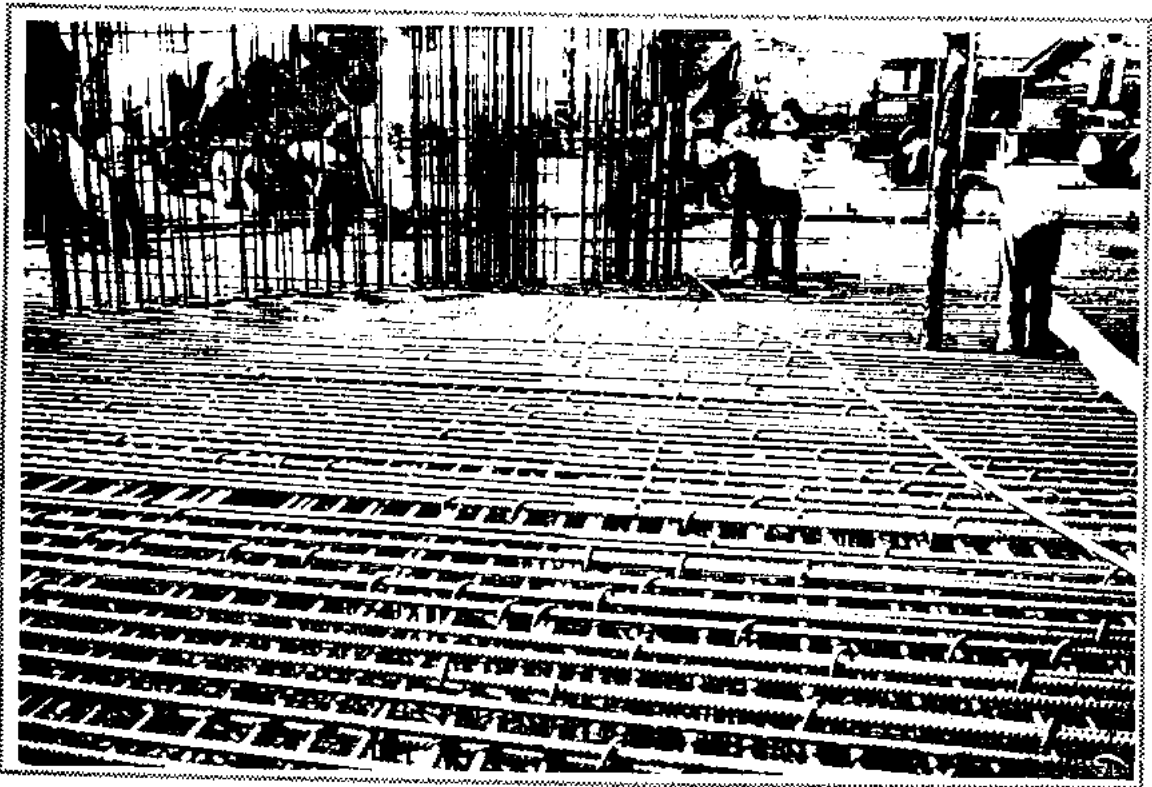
La centrale ENEL di Monfalcone (1979): la fondazione armata
